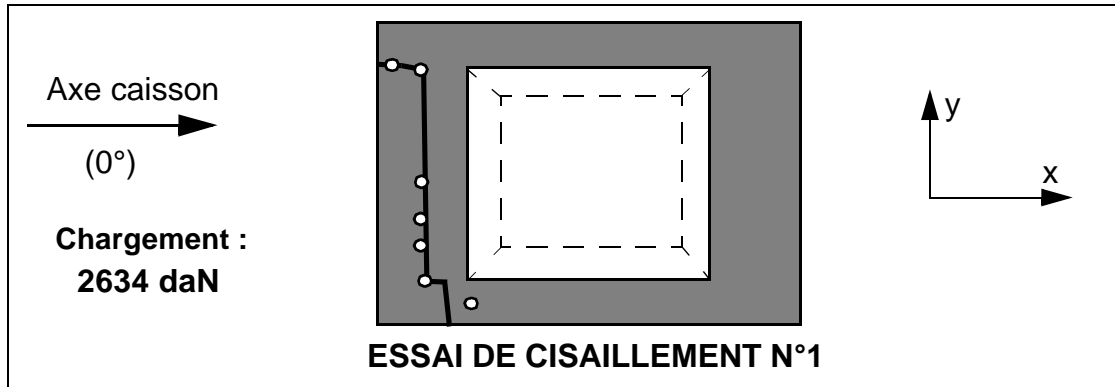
Faciès de rupture essai de cisaillement n°1 (Photo N° A2-10).
